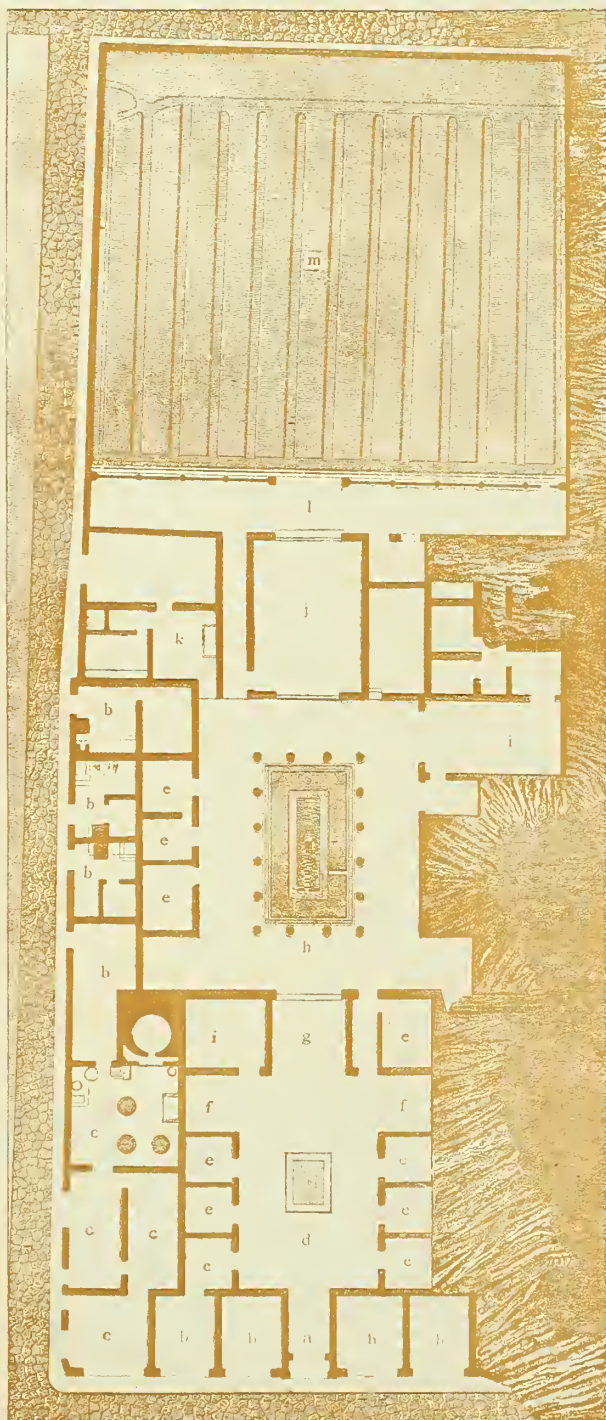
PLANTA DE LA CASA DE PANSA EN POMPEYA, SEGÚN MAZOIS (Núm. 16 del plano fig. 619)
